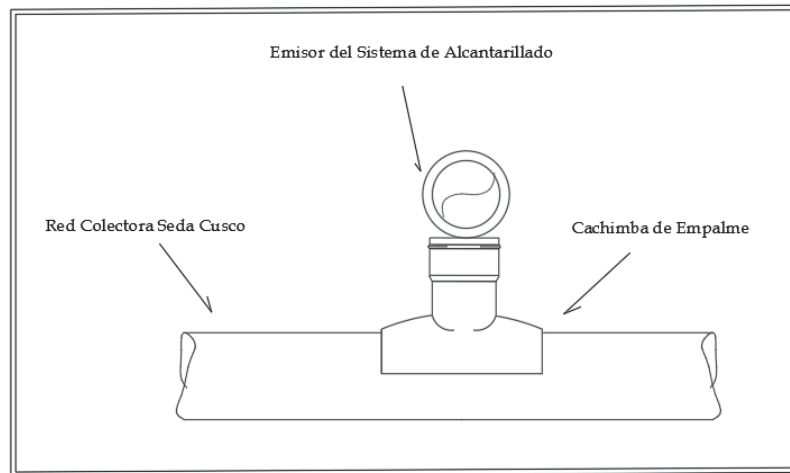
Esquema de conexión a la red colectora Seda Cusco-Vista Planta a.
